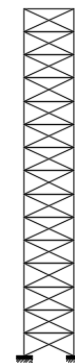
Denah Perletakkan Balok dan Kolom Struktur 15 Tingkat
